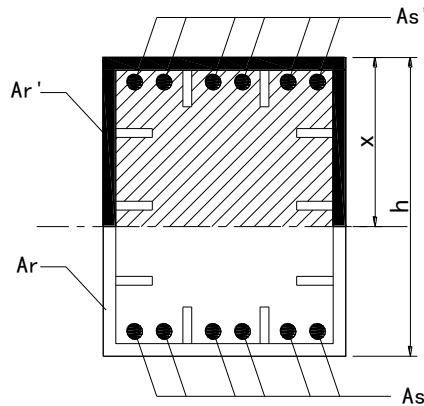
钢壳-混凝土组合塔正截面承载力计算参数示意
